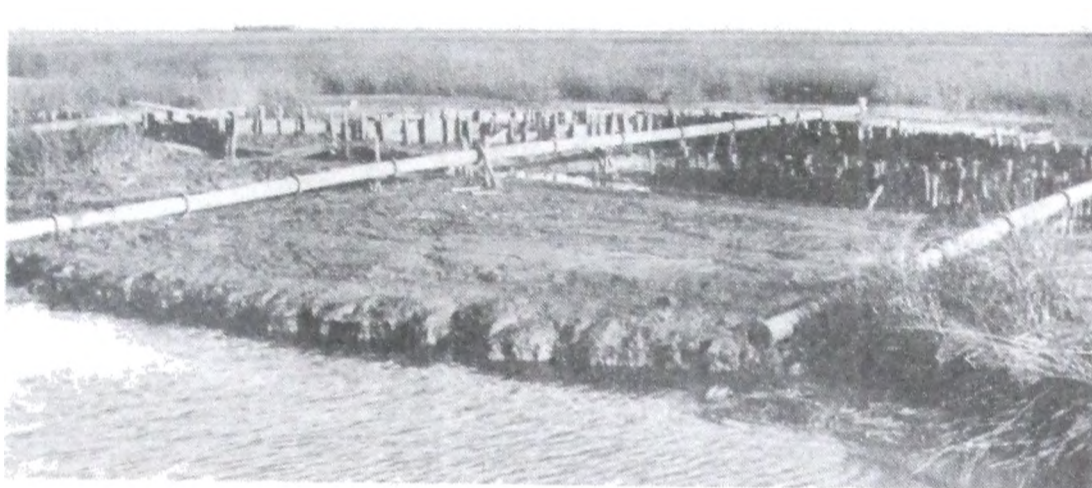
Plan de obras de «El Tordillo». Trecho del Canal Principal terminado.
